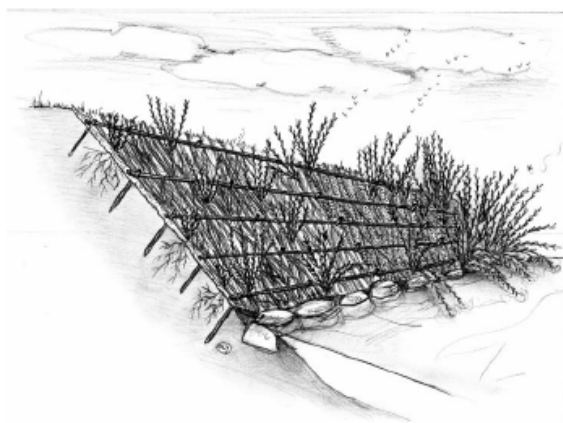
Vista prospettica di copertura diffusa con ramaglia viva
